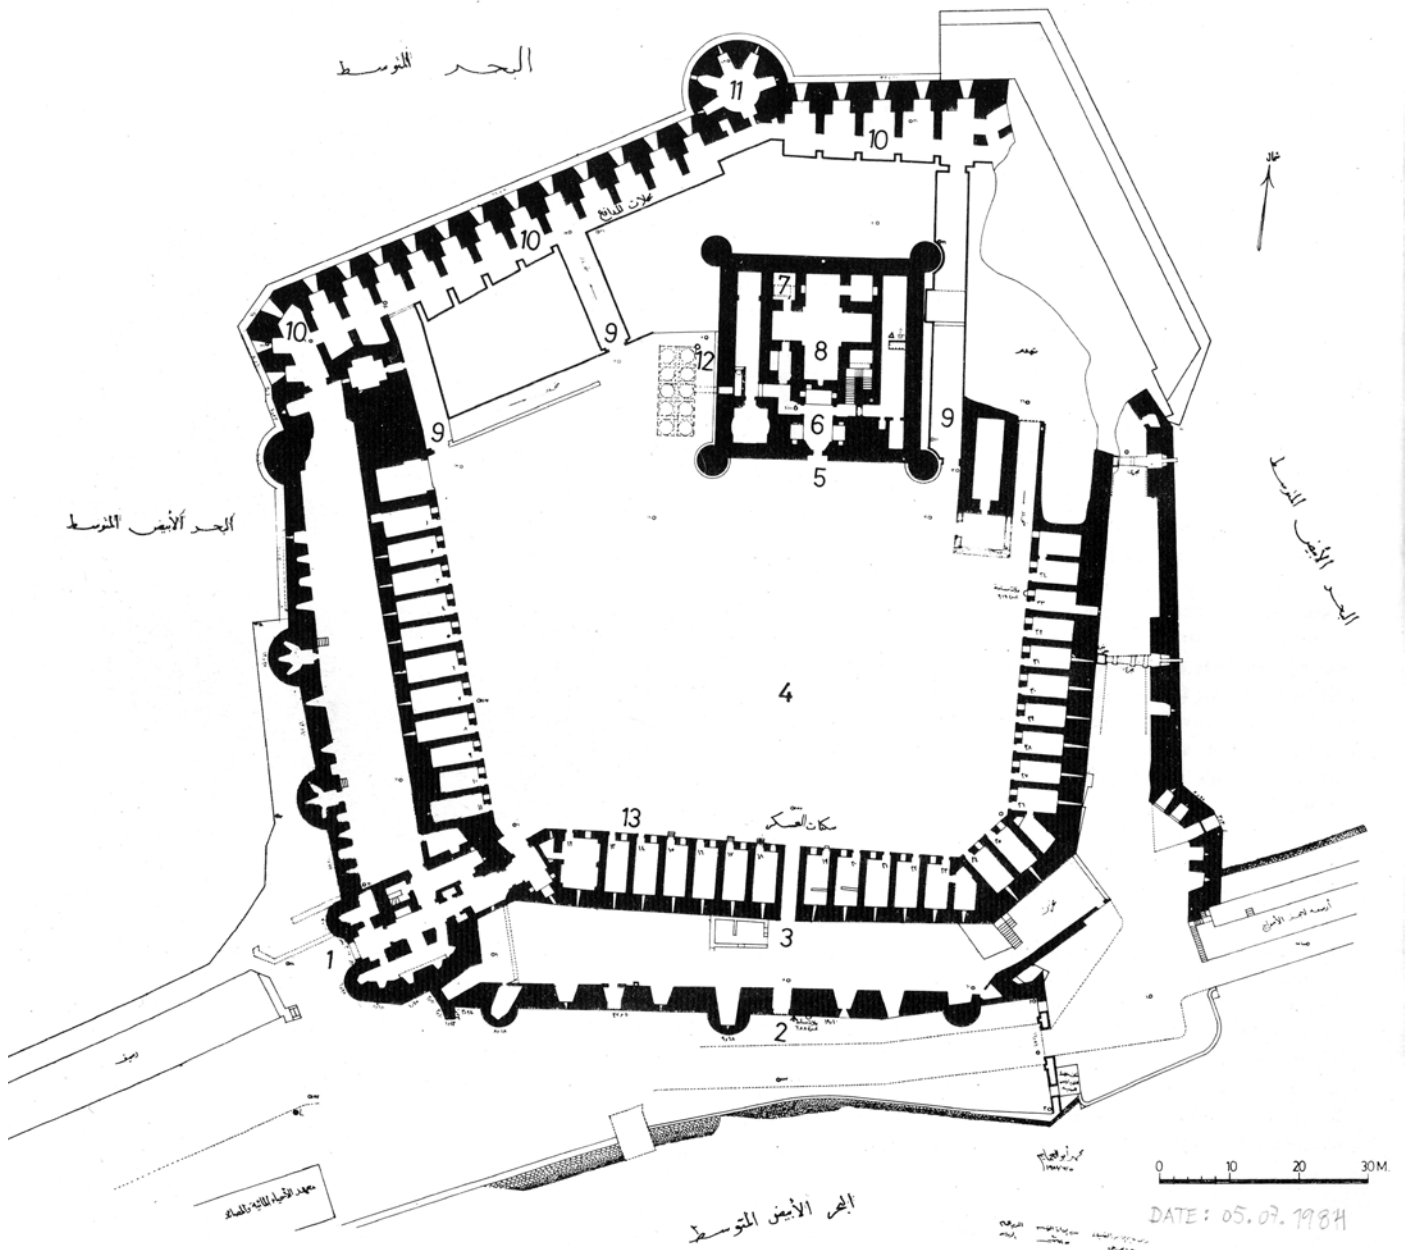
Lageplan (SAFWAT EL-ALFY 1984).
